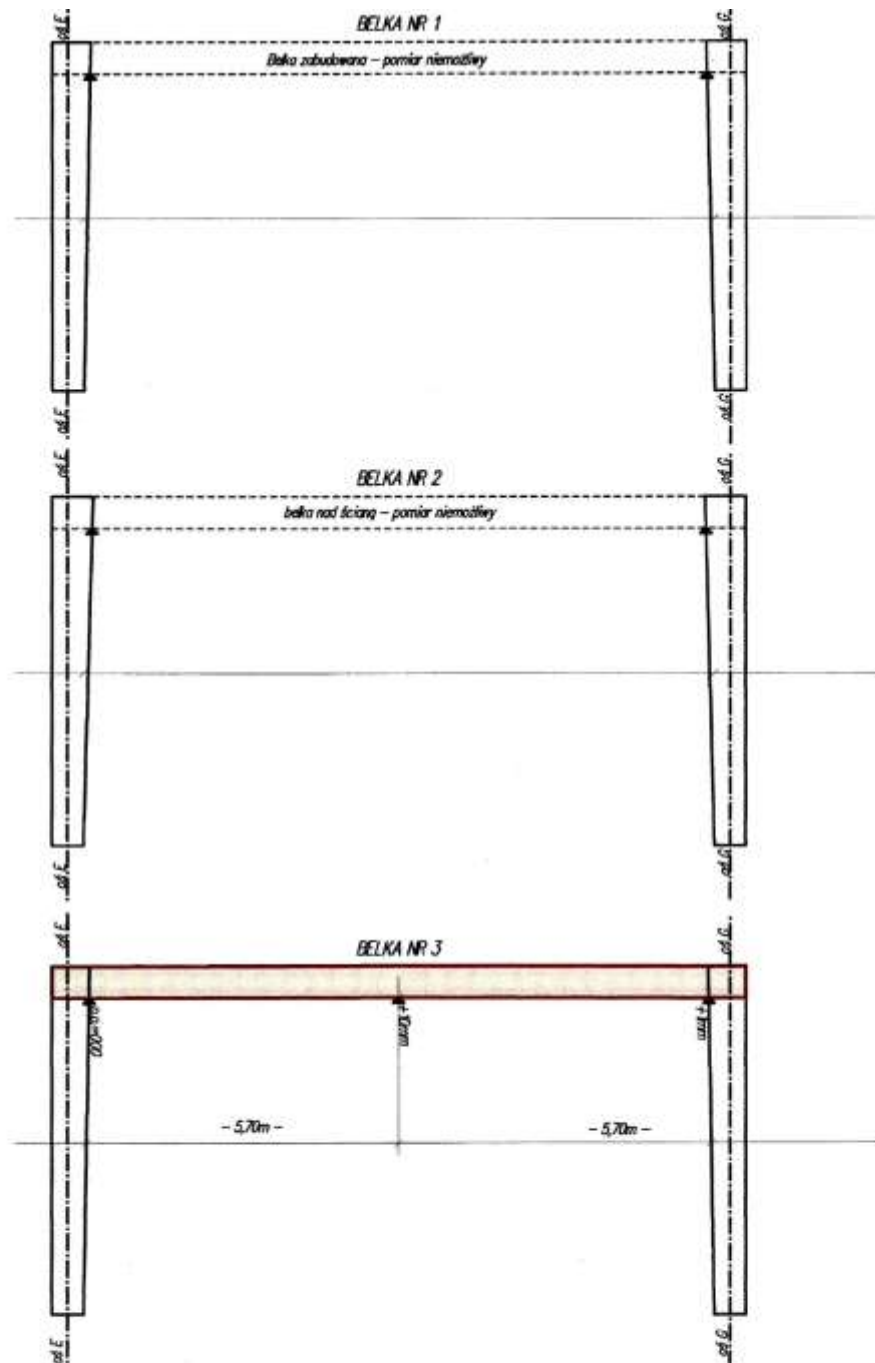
Rzut piętra – oznaczenie dźwigarów strunobetonowych
